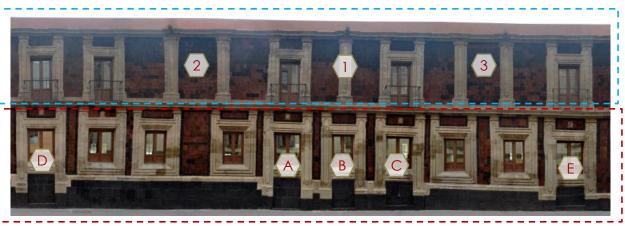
Sección de fachada correspondiente a un núcleo de las viviendas de alquiler que correspondiendo al conjunto de los Padres Camilos.
